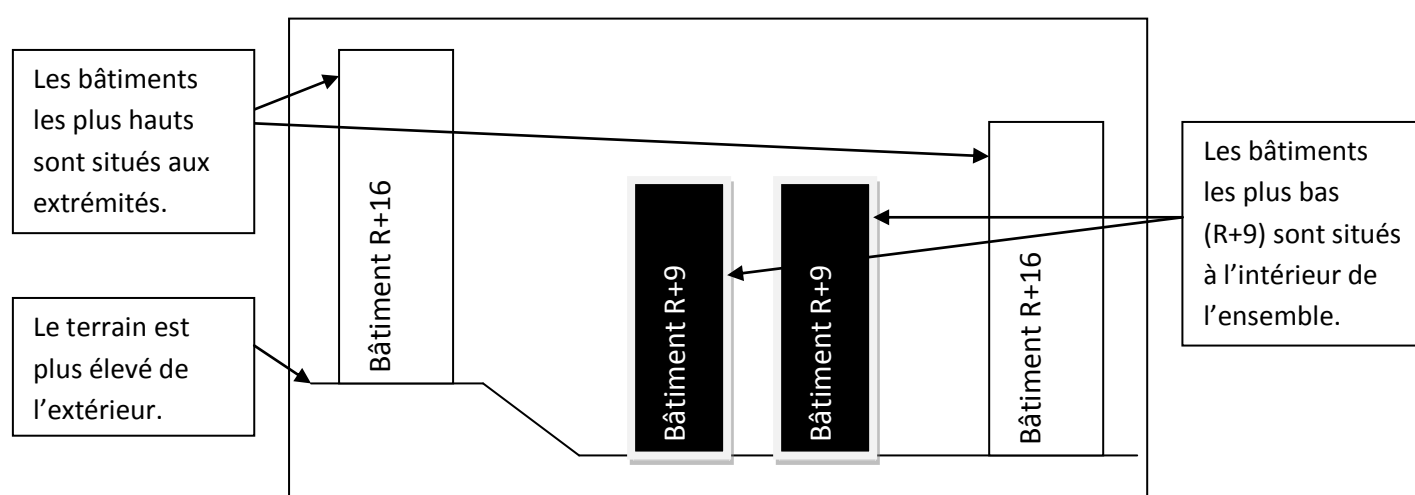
coupe sur le plan de masse montrant la morphologie du terrain et le positionnement des bâtiments.
